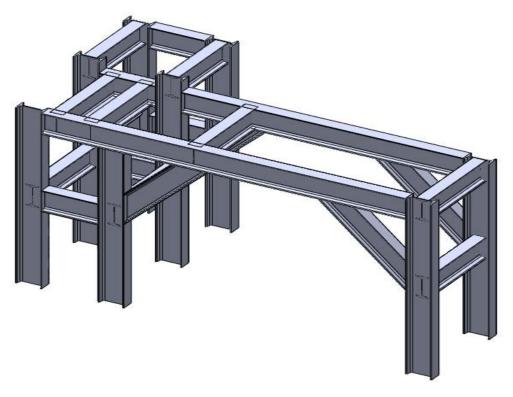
Base o estructura metálica con Perfiles tipo I. C, Jiménez.
